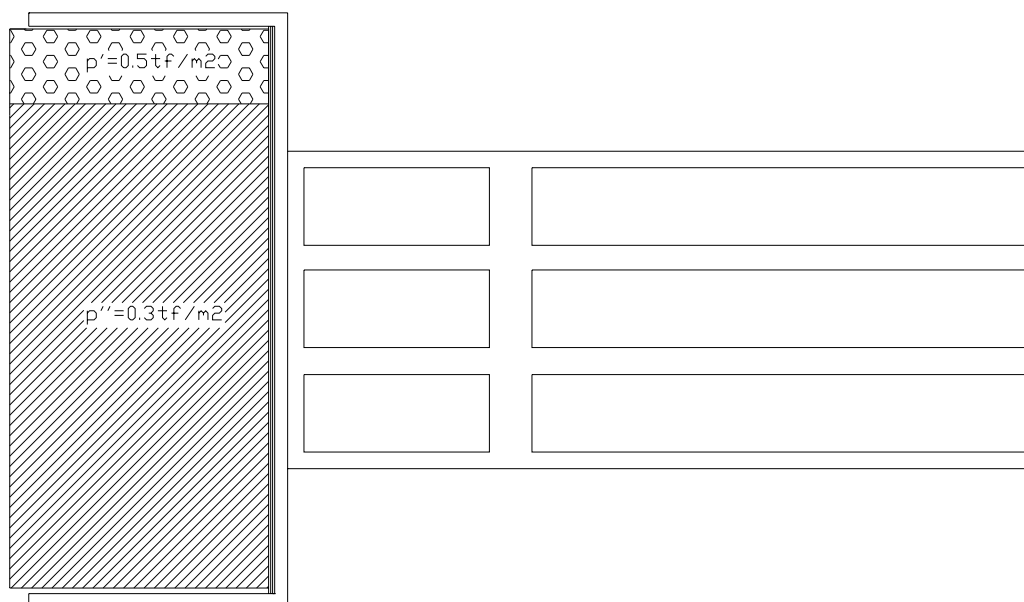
Cálculo do empuxo de sobrecarga nas cortinas considerando o veículo sobre a ponte (vista em planta)
